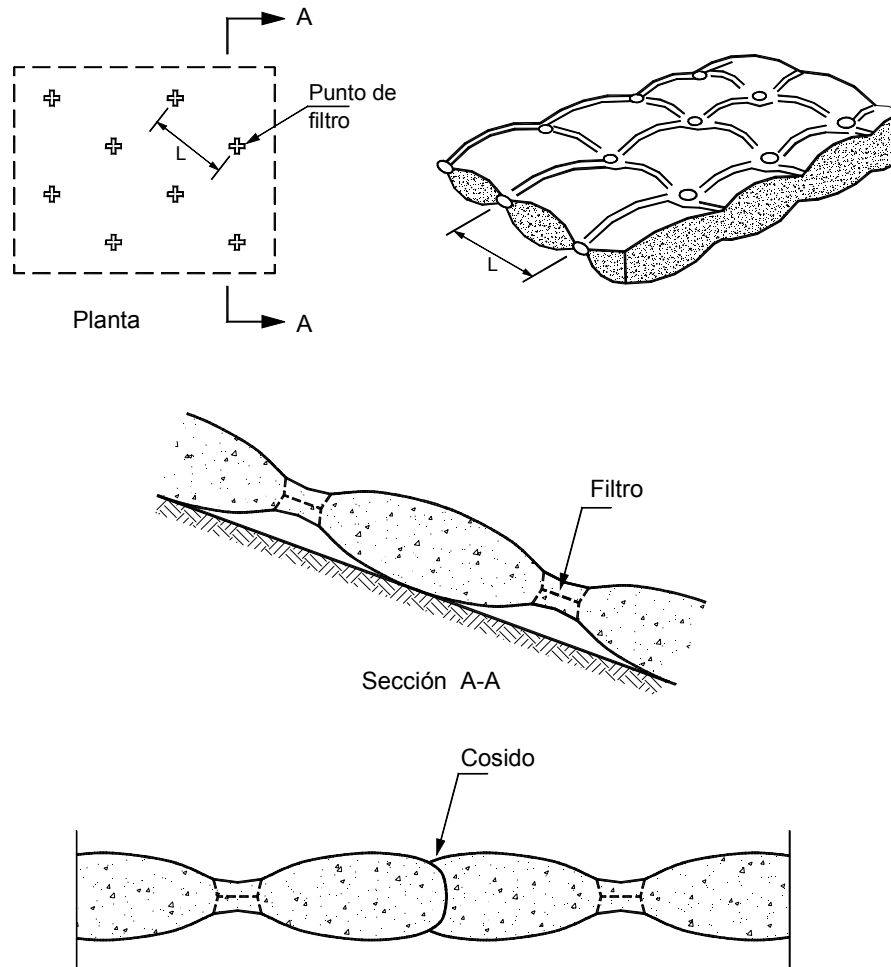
Detalles de la construcción de geotextiles rellenos de concreto.
